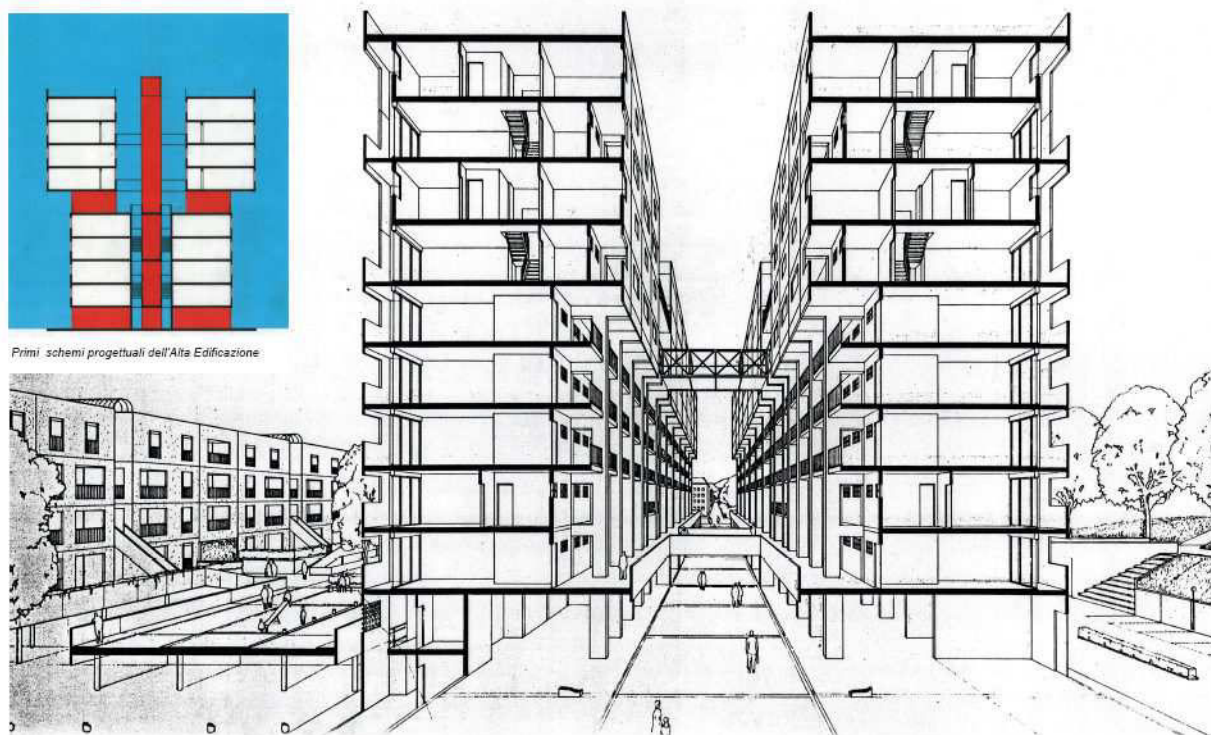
Sezione prospettica del gruppo coordinato da Pietro Barucci del quartiere Taverna del Ferro
